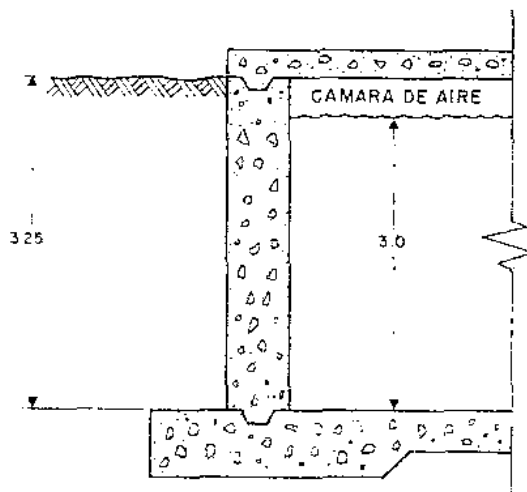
Corte esquemático de estanque de concreto, articulación entre paredes, techo y piso.
